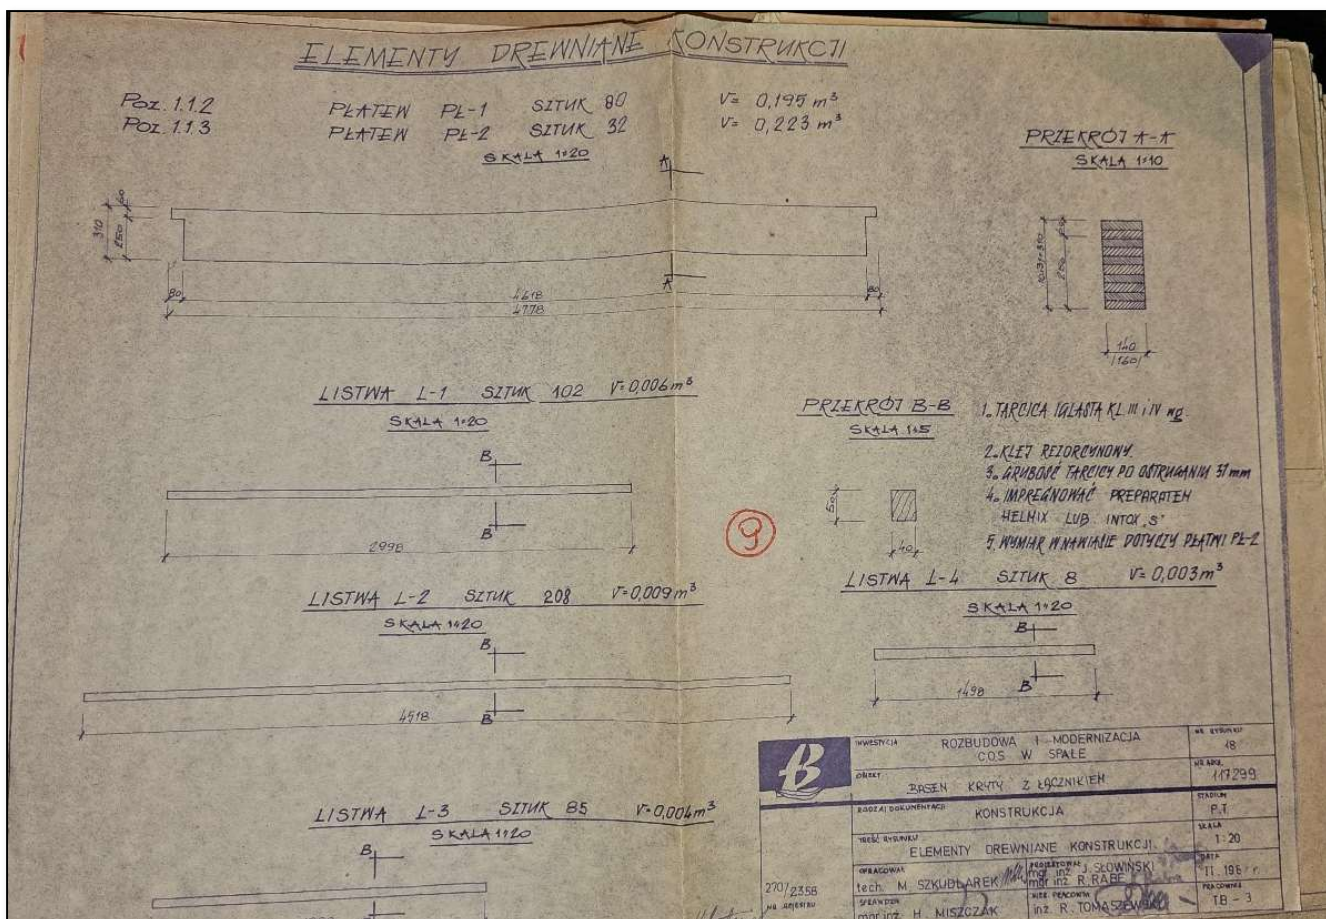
Archiwalna dokumentacja projektowa. Schemat konstrukcji dźwigara i ułożenia płatwi z drewna klejonego.
